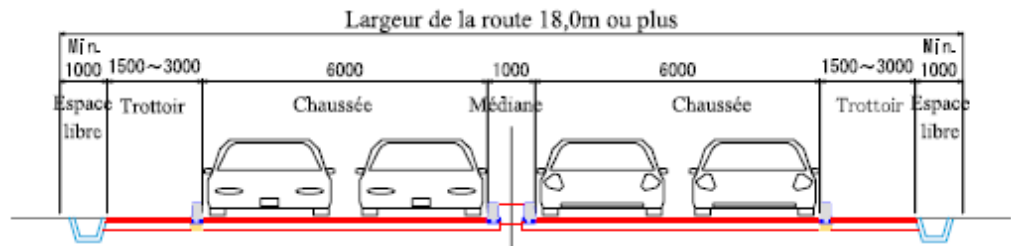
Section standard de la route est-ouest (R-2)
